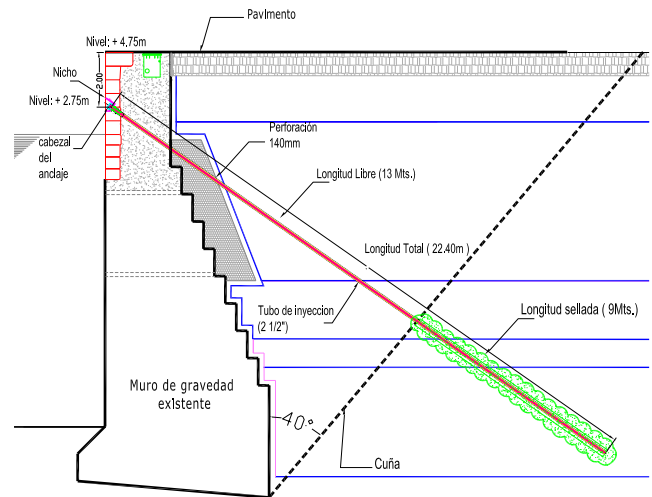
Solución ad-hoc propuesta para reforzar los muros de gravedad existentes
